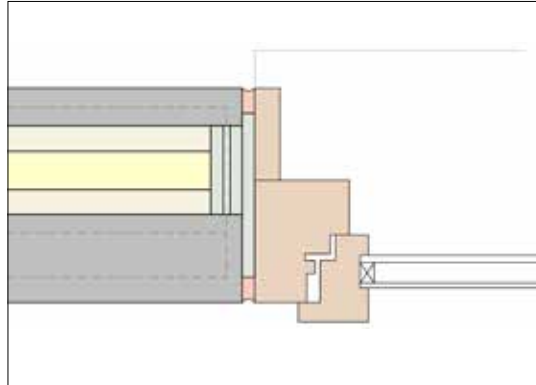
Fassaden-Sandwich-elemente (FSE), Einbindung Fenster (kbp)
